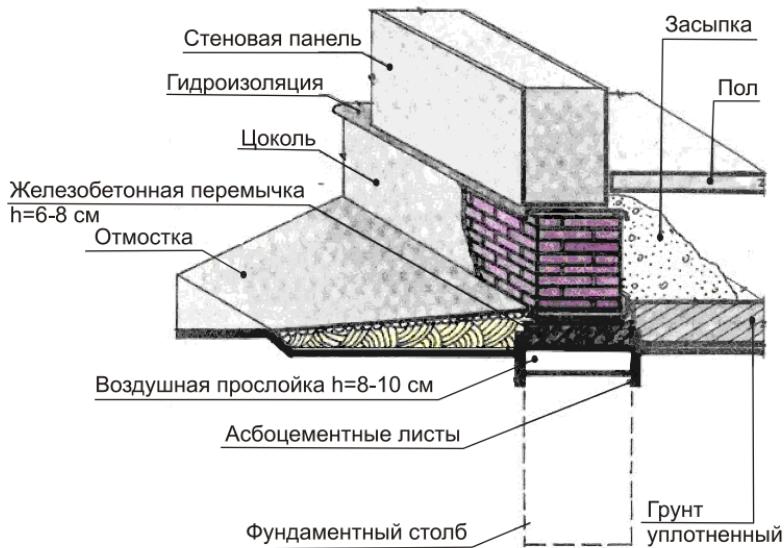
Конструкция фундамента с теплым подпольем и кирпичным цоколем
